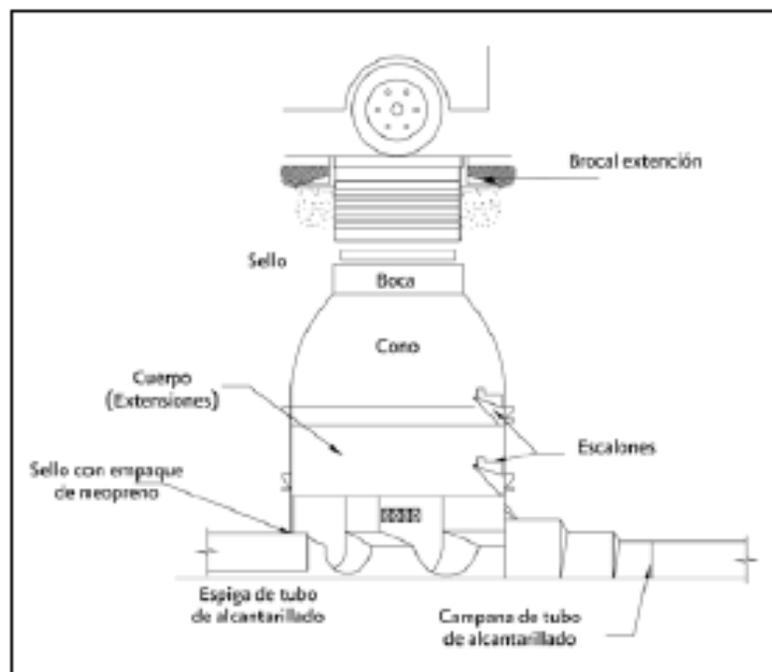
Ensamble Pozo prefabricado (Conagua, 2009)
